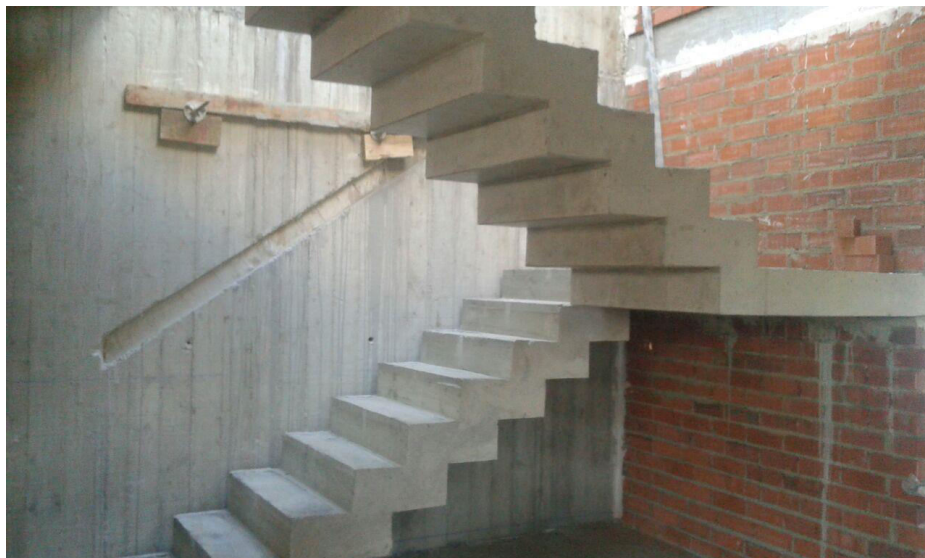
Desencofrado y apuntalamiento de escalera.
